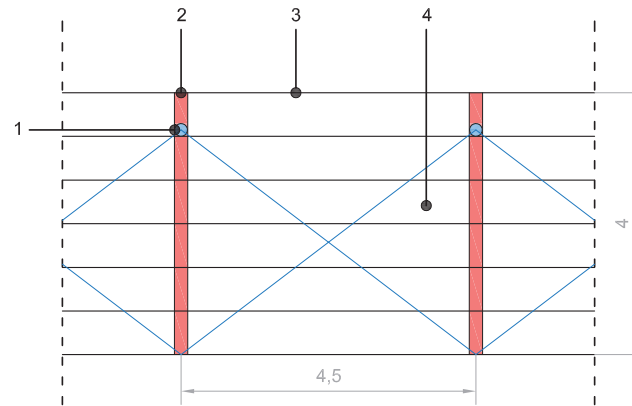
Esquema planta estructura marquesina antigua estación de Jesús
